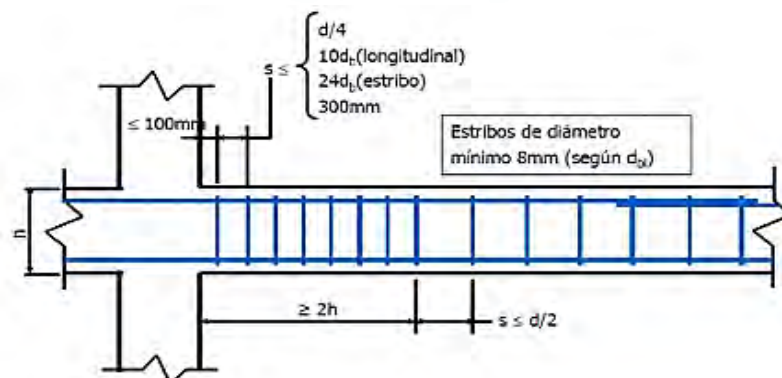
Requerimientos de estribos en vigas (Higashi, 2020)
